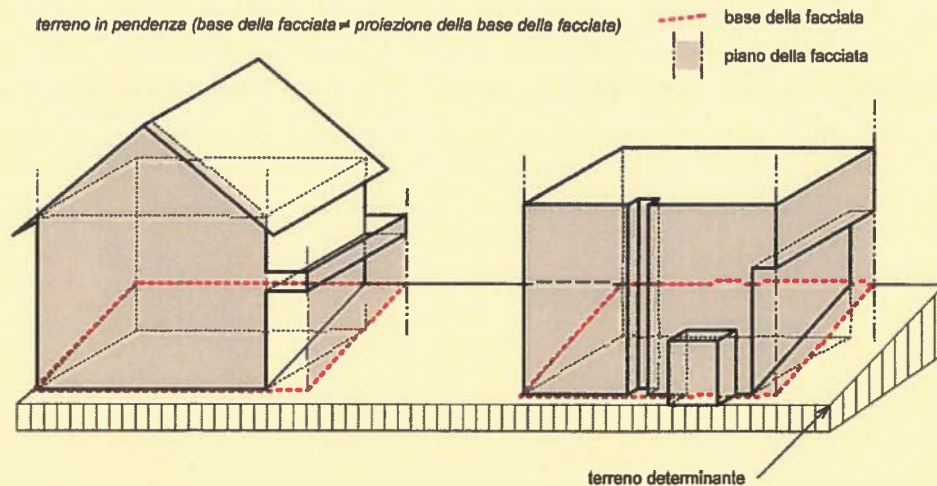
3.3 Piano della facciata e base delle facciate
